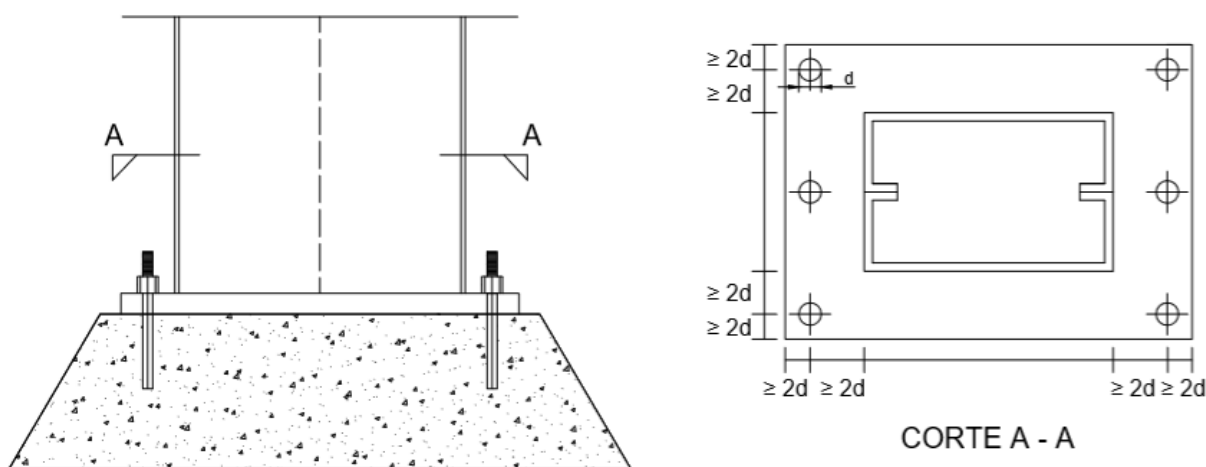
Base para pilares engastados (De PAULA, 2016)
